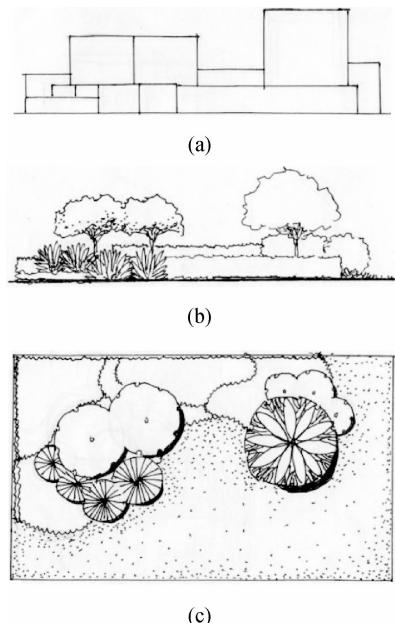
抽象的立面组合转换为植物景观设计平、立面图
